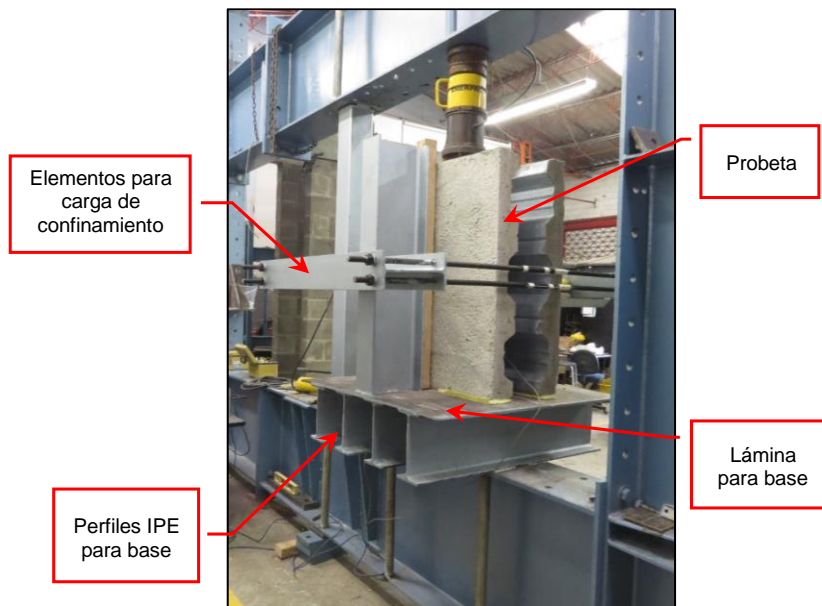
Vista posterior montaje de ensayo. Fuente: Elaboración propia
